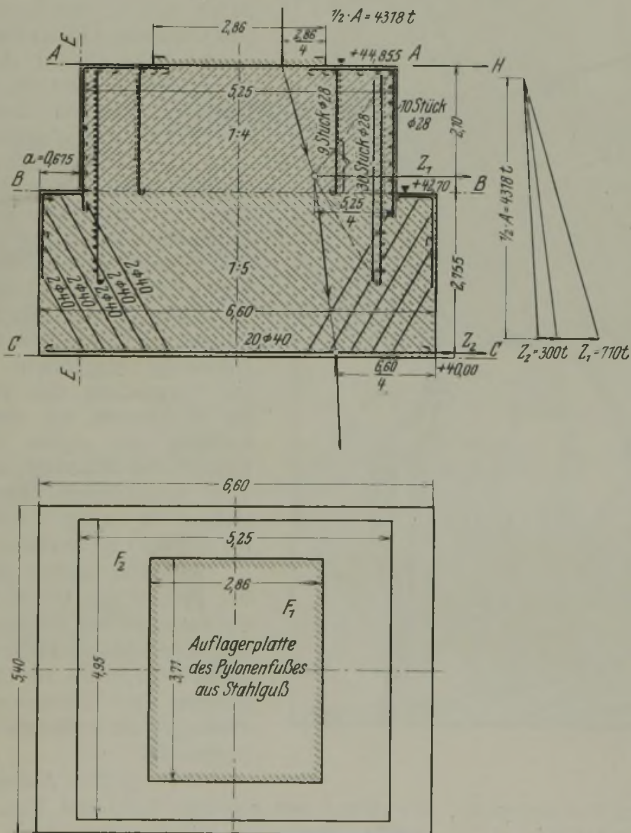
Bewehrungsplan für die Auflagerquader in den Pylonenpfeilern mit Kräfteplan; Grundriß des Auflagerquaders.
